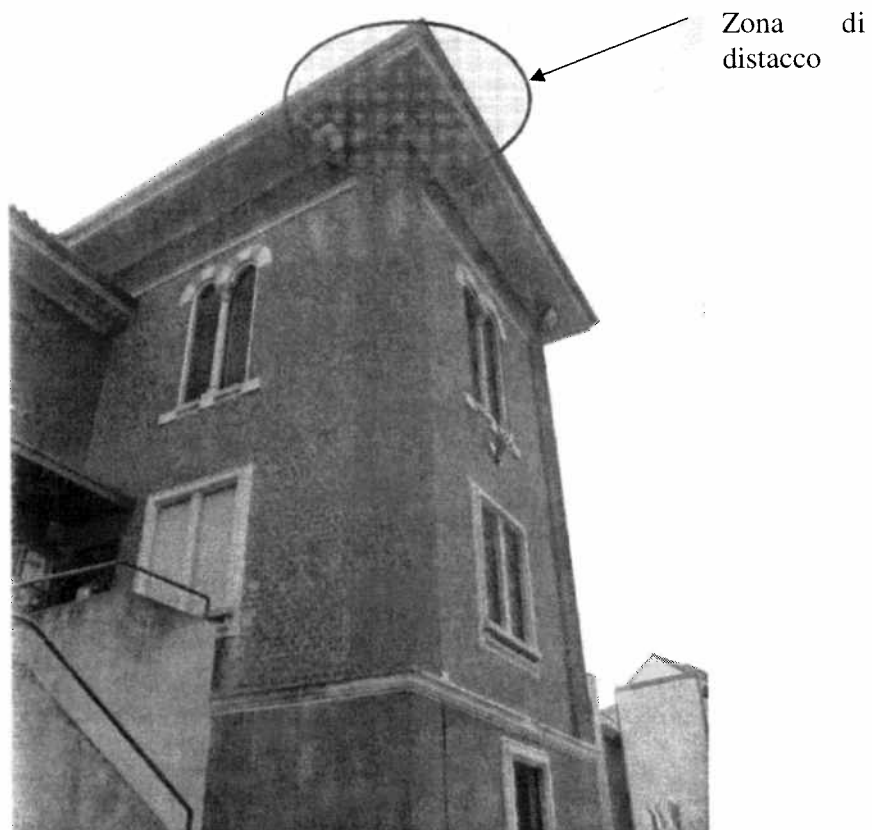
Edificio oggetto d'intervento – prospetto sud-est
